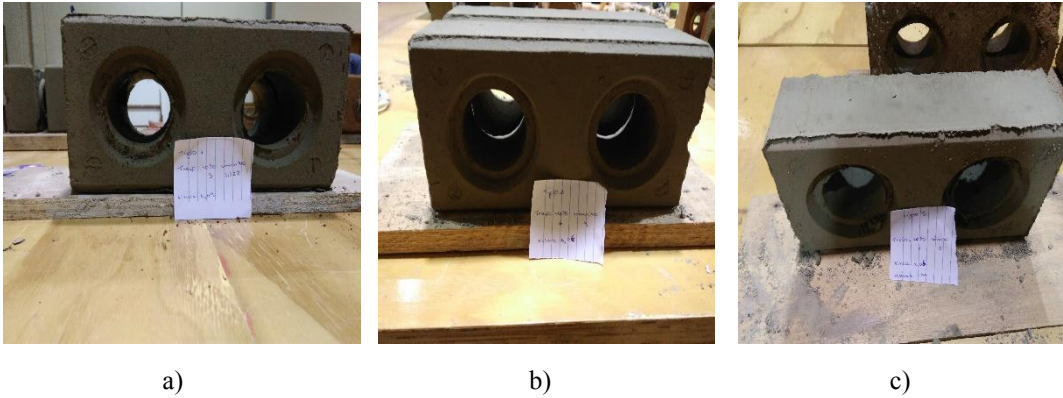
a) primeiro tijolo; b) segundo tijolo; c) Terceiro tijolo
